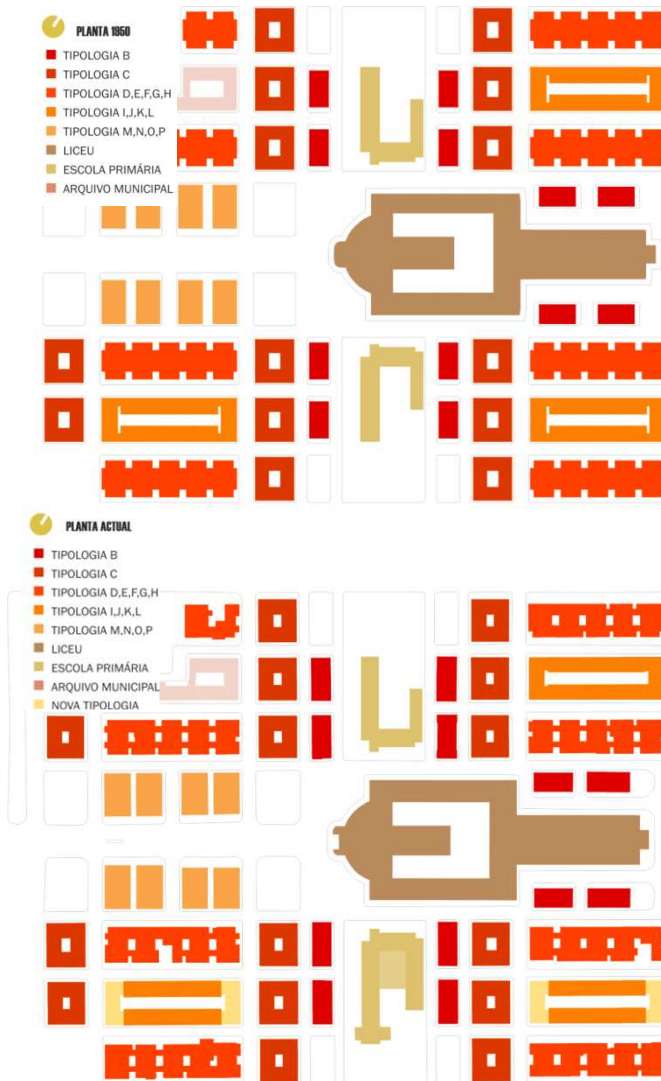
Planta de 1950 e planta actual do Bairro Social do Arco do Cego [7].
